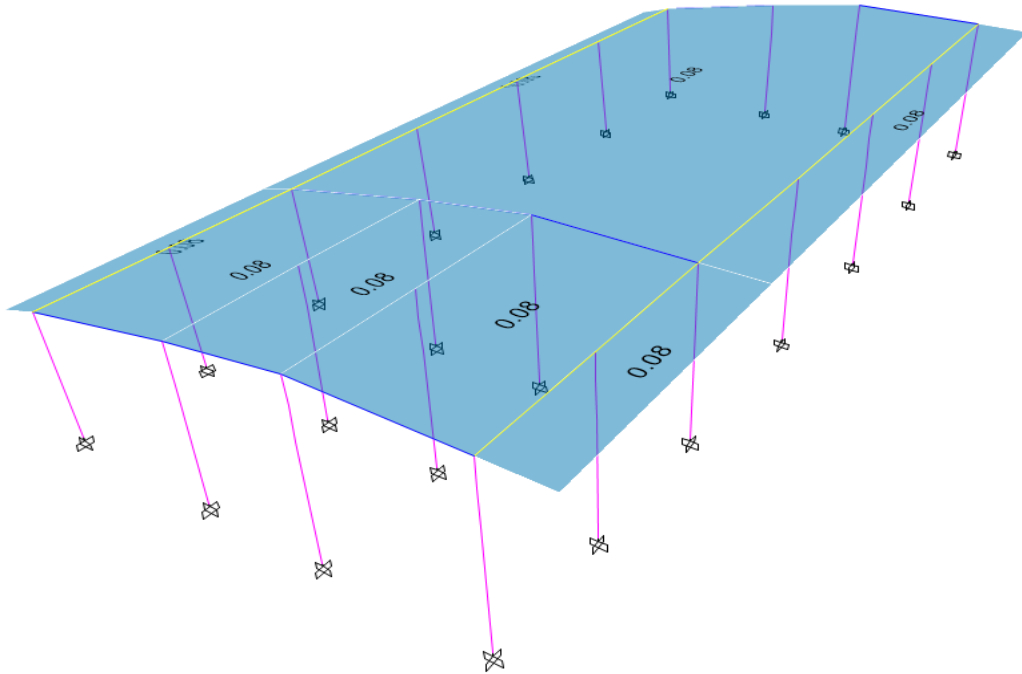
Vista 3d modelada – carga muerta (Edif . N° 03 – Gimnasio)
